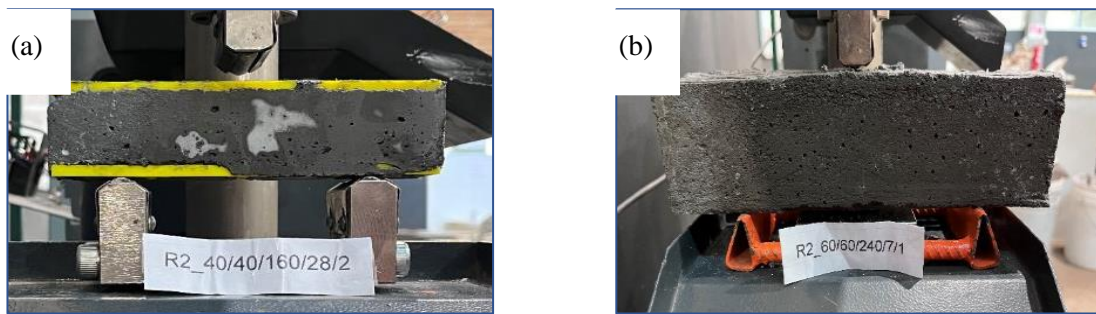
Probetas montadas en máquina de ensayo. (a) R2_40/40/160/28/2 y (b) R2_60/60/240.
